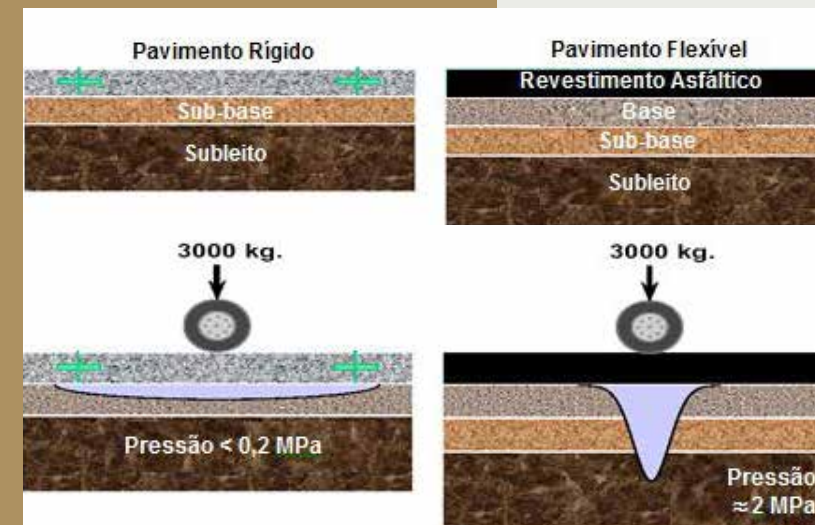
Distribuição de cargas nos pavimentos rígido e flexível
